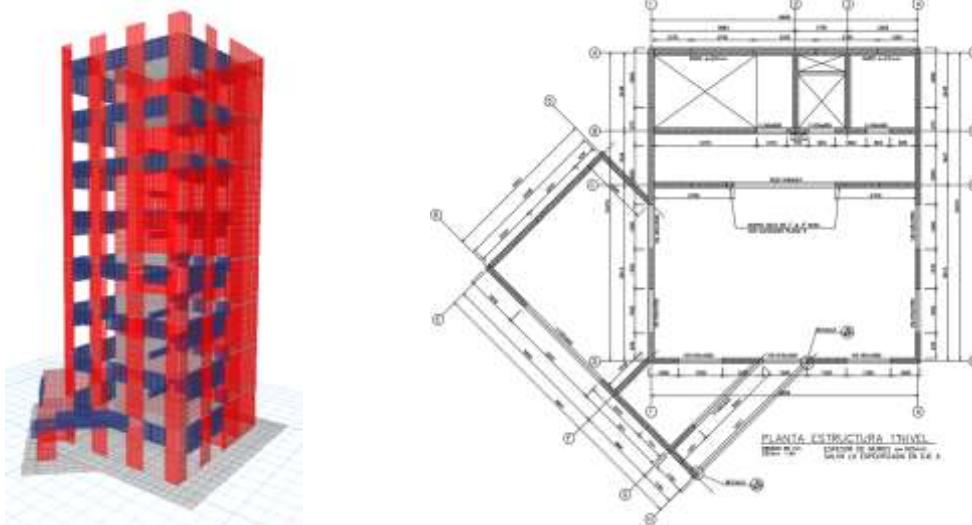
Modelo estructural vista 3D y planta primer nivel
